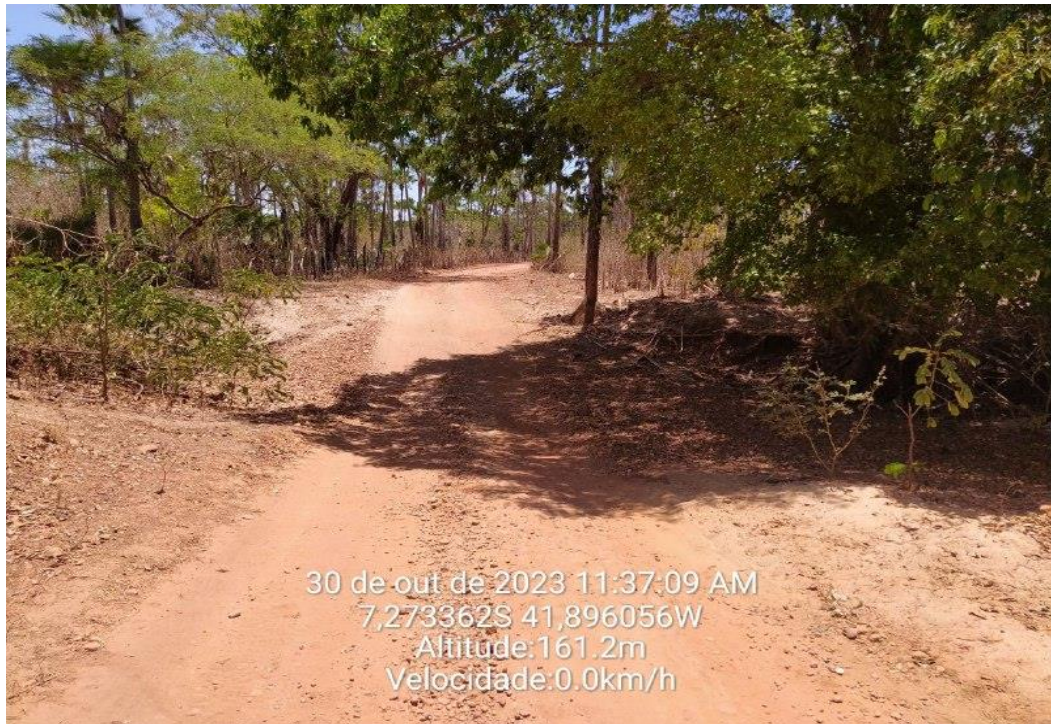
PASSAGEM MOLHADA 05 - TRECHO 04
